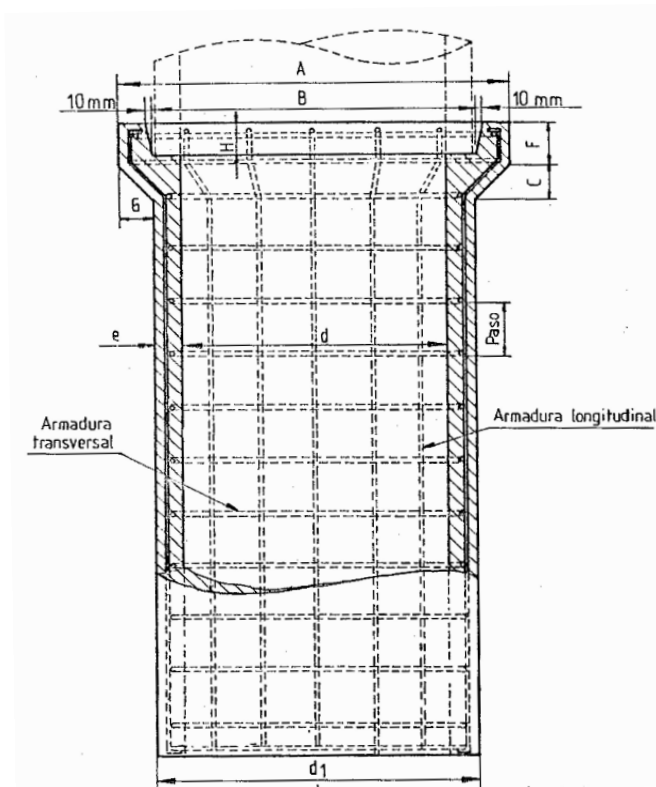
Armadura transversal y longitudinal (IRAM 11629)
